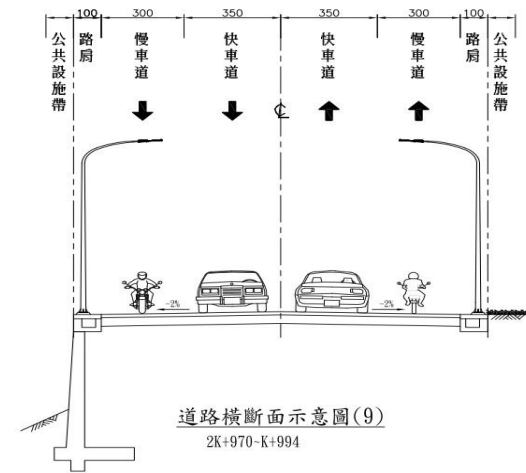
本計畫道路拓寬工程之道路施工段標準斷面示意圖(一)
